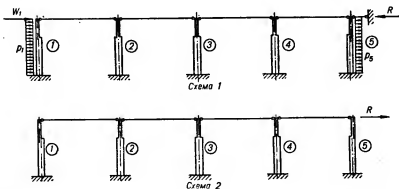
Схемы расчета многопролетного поперечника с ригелями в одном уровне на ветровую нагрузку.
